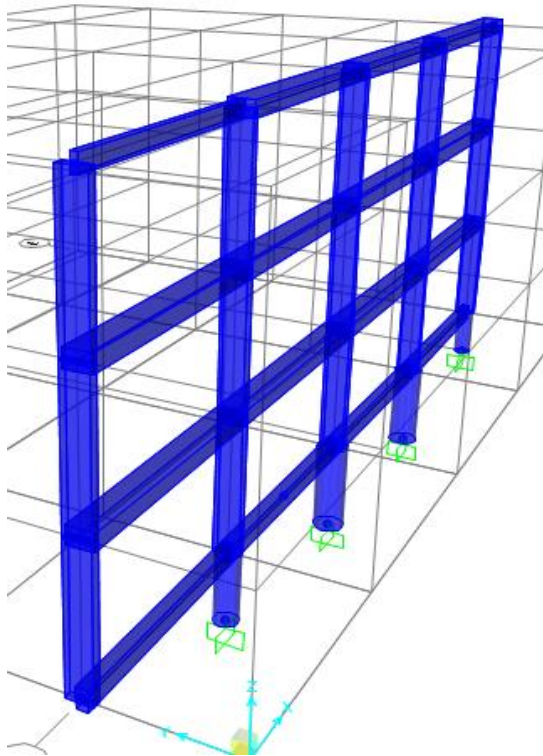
Vista 3D para control de orientación de los elementos estructurales SAP2000
